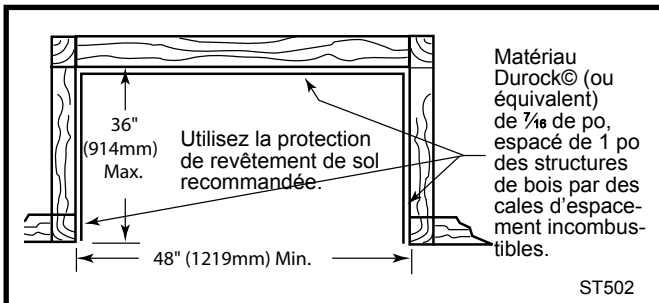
Plan du sol. Du placoplâtre sur le devant avant se joint au revêtement de l'alcôve en Durock® (ou équivalent).
